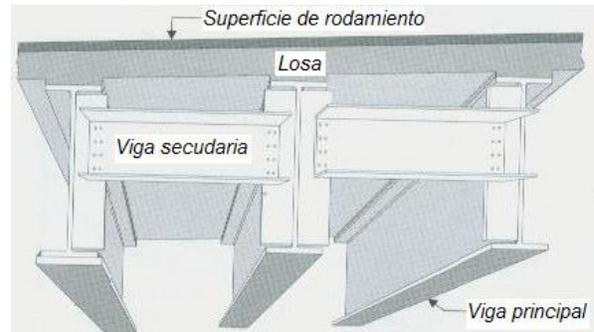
Elementos de una superestructura de vigas de acero (MOPT, 2007)
